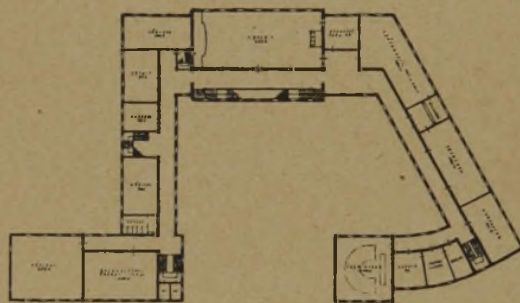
Grundriß I. Obergeschoß. (1 : 1500.)
